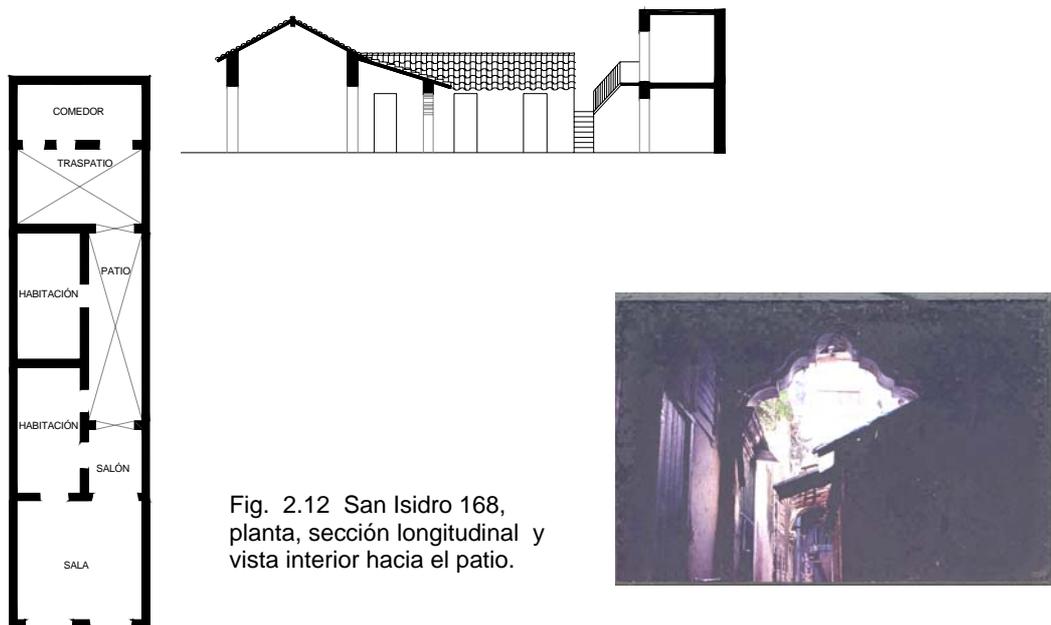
San Isidro 168, planta, sección longitudinal y vista interior hacia el patio.
